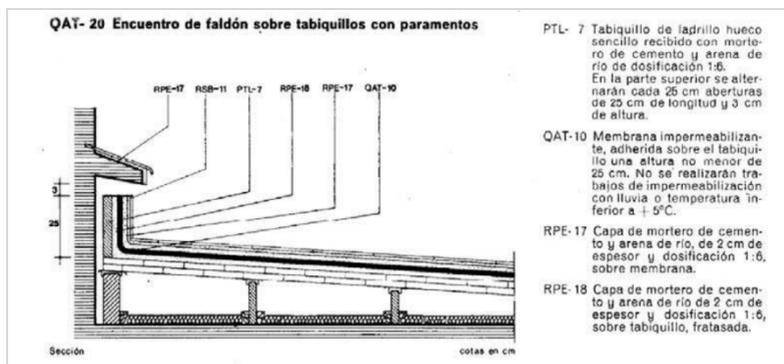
Detalle de encuentro de faldón sobre tabiquillos con paramento. Fuente: NTE-Cubierta QAT Azotea transitabile 1973³⁴.
